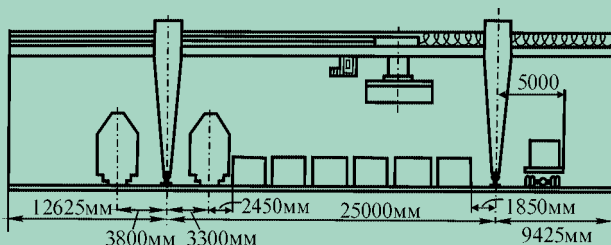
Схема размещения и переработки крупнотоннажных контейнеров козловыми кранами КК-20 пролетом 25 м
